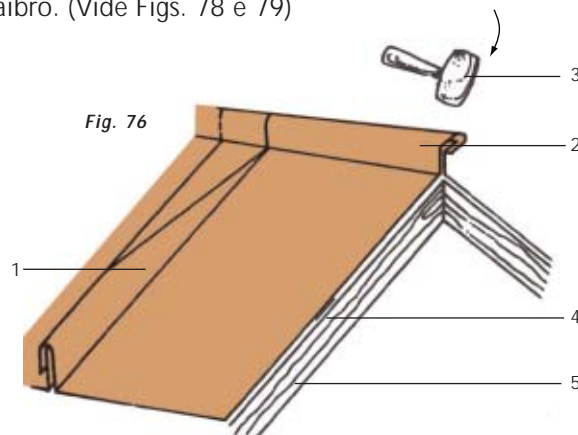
Detalhes construtivos da junta elevada da cumeeira.
